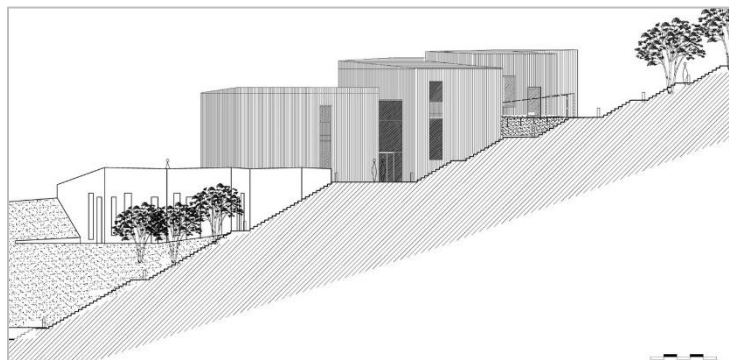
Fachada. Rue Royale Architects (2013). Sticky Fingers, Cultural Center
